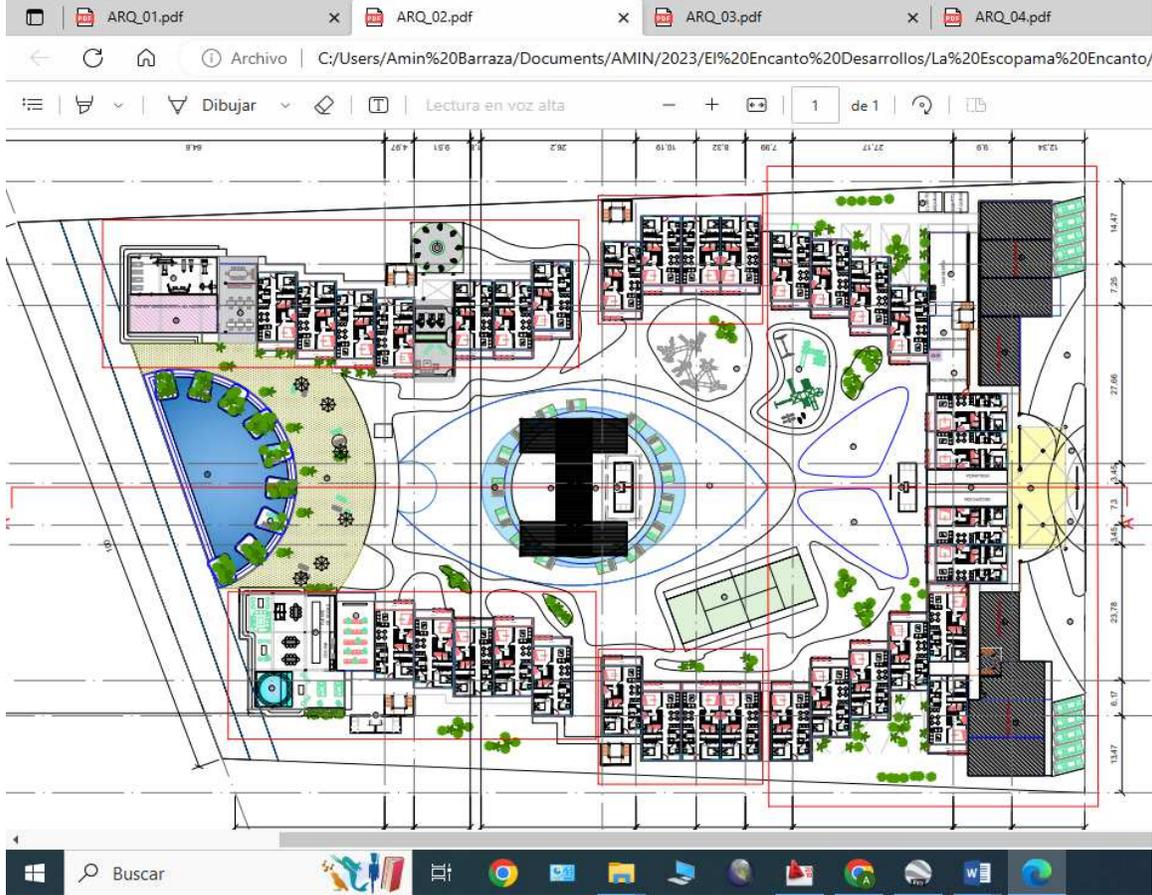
Planta arquitectónica nivel 1. Ver Anexo 4. Plano Arq-02.
